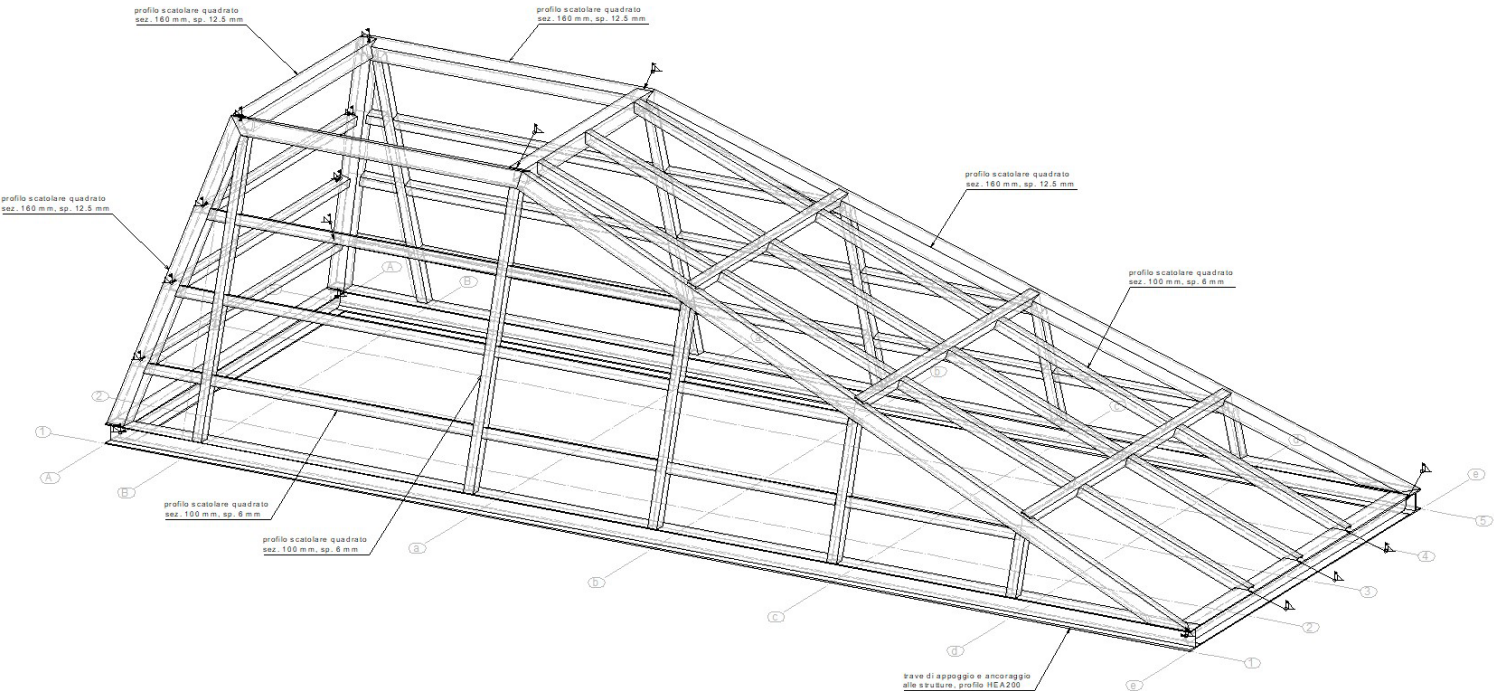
Vista 3D assometrica degli elementi strutturali metallici del lucernario
